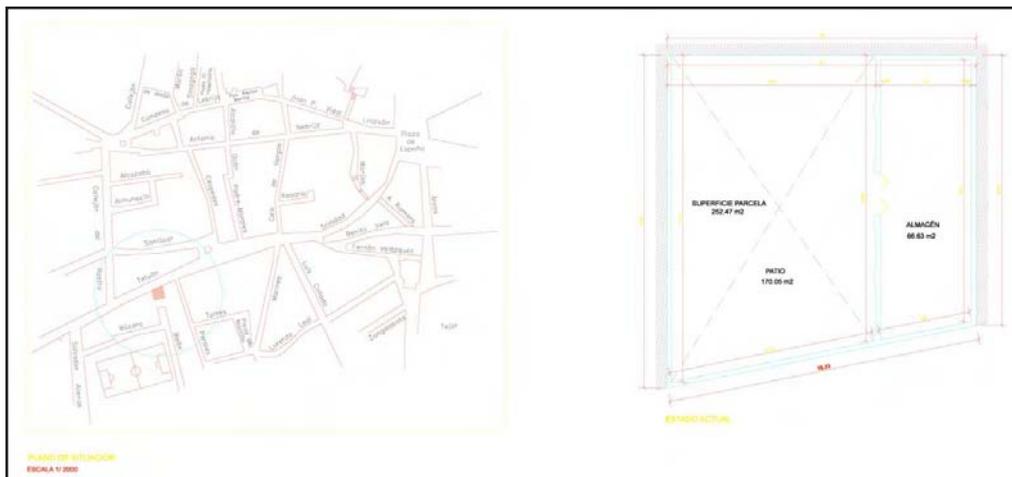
Situación y planta de la parcela nº 41, de la C/ Tetuán de Lebrija. Sevilla.
